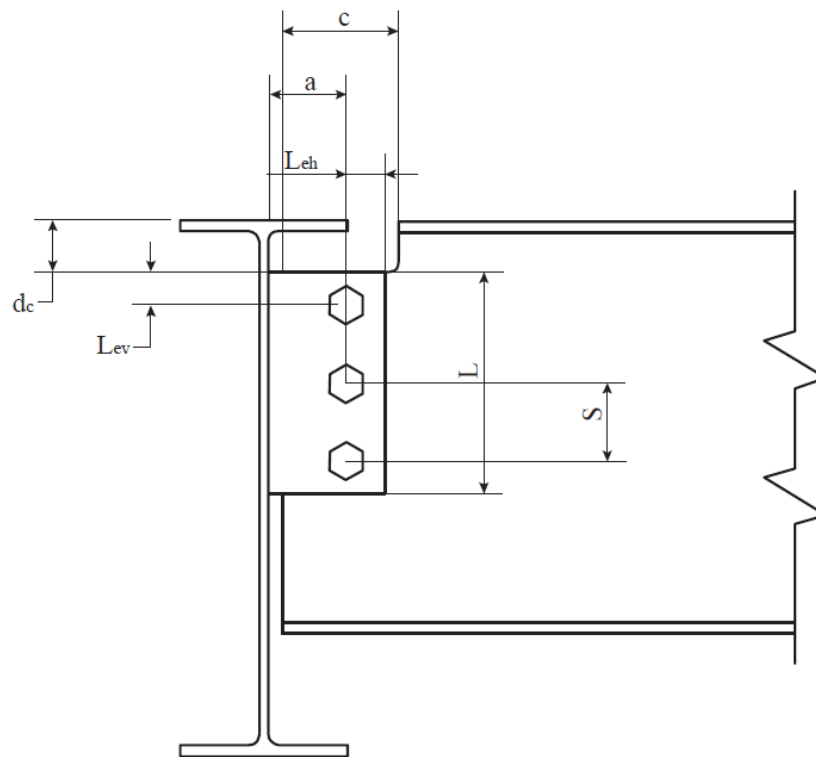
Detalle de conexión vigueta-viga o viga-viga (conexión simple o de corte)
